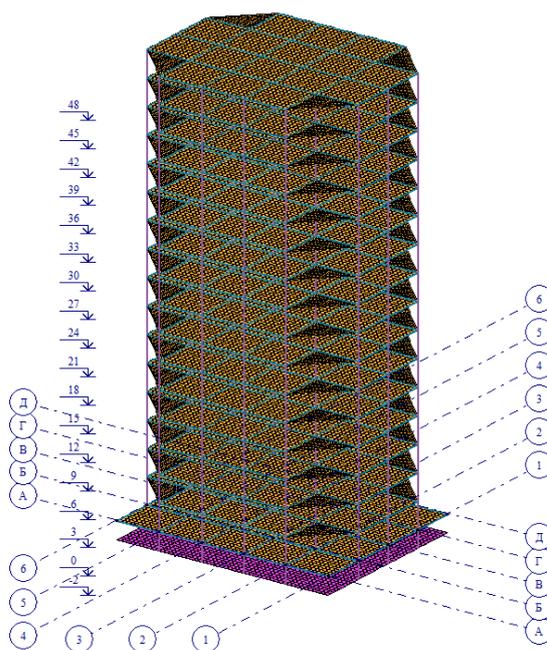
Расчетная схема здания в диметрической проекции
